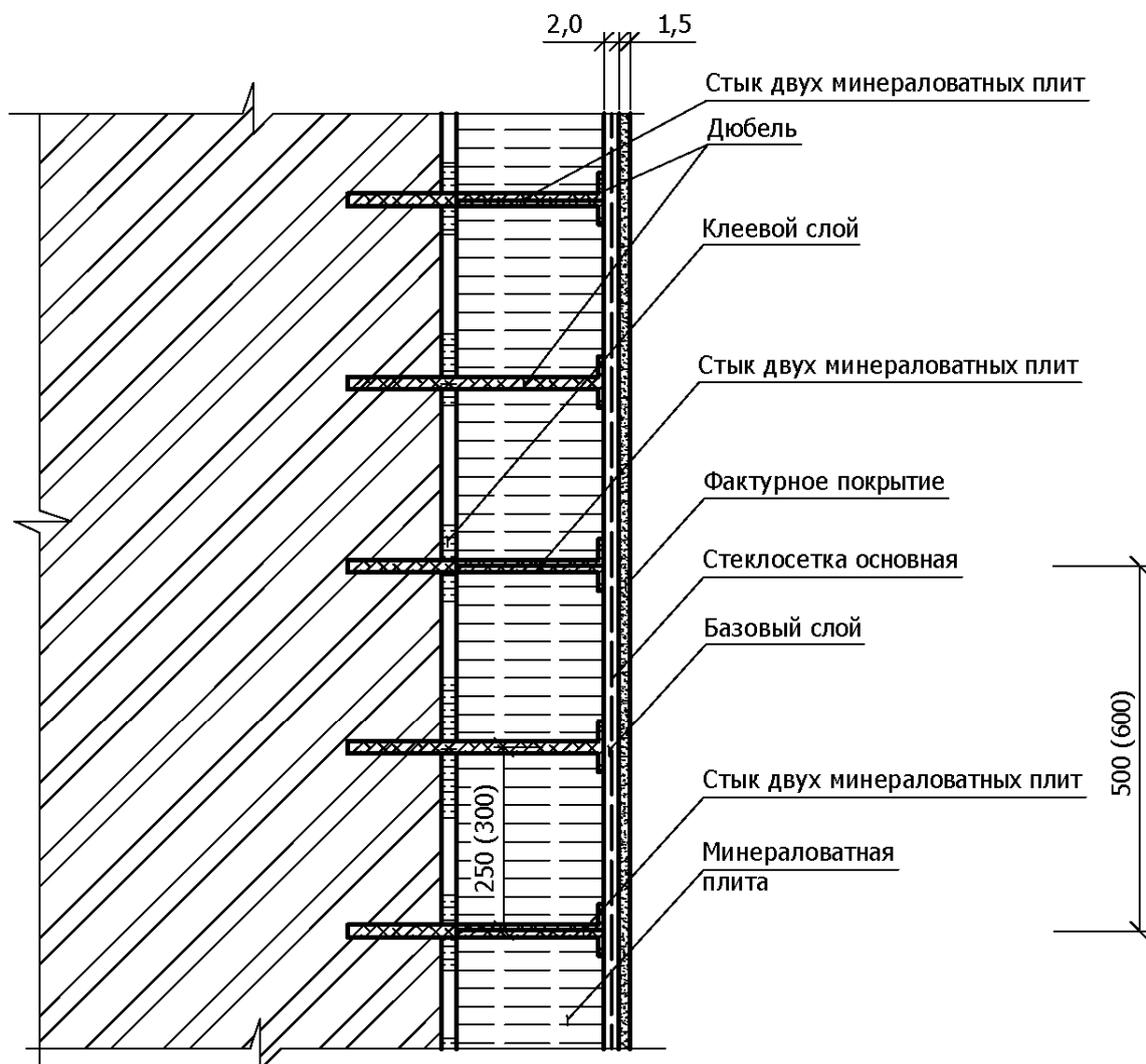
Установка плит утеплителя с подогнанными по месту вырезами
